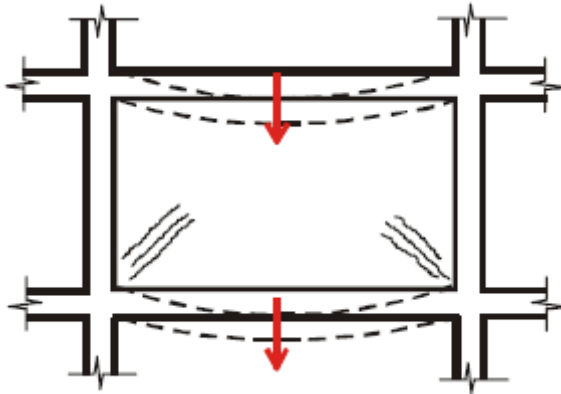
Trinca em parede de vedação: Deformação do suporte inferior menor que a deformação da viga superior.
